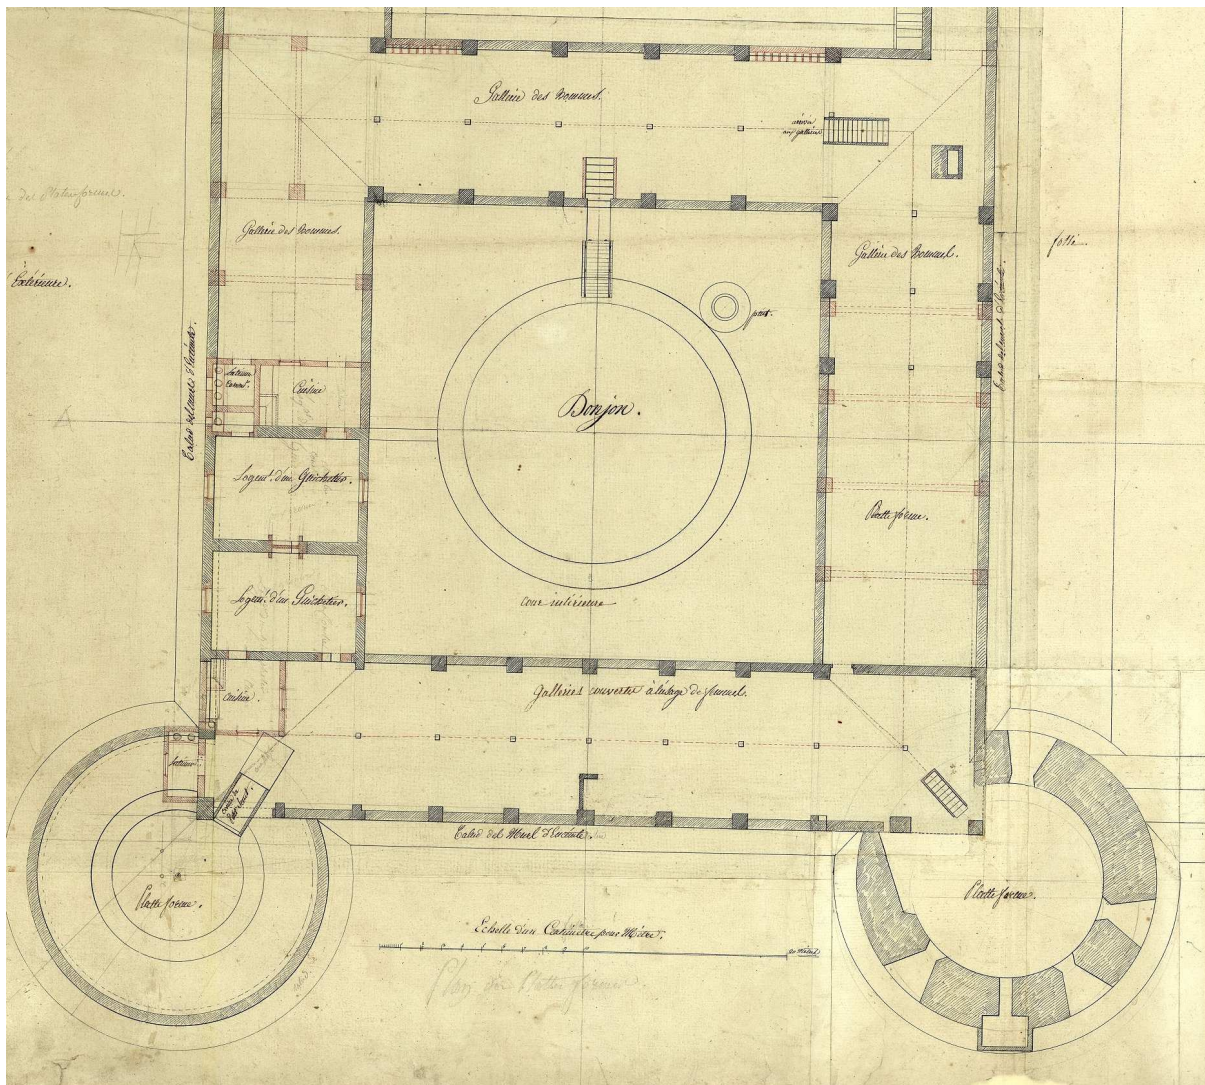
rilievo Maguin,1807-stralcio 3° cortile piano secondo
